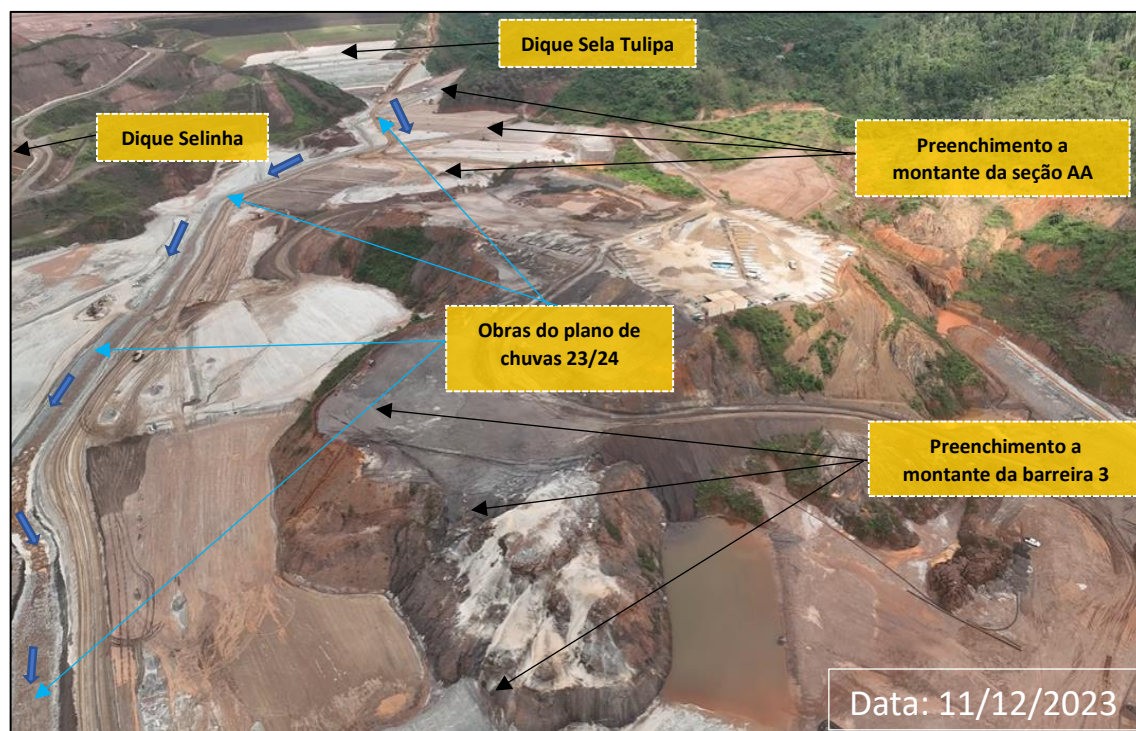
Vista das Obras do Vale do Fundão em Andamento
